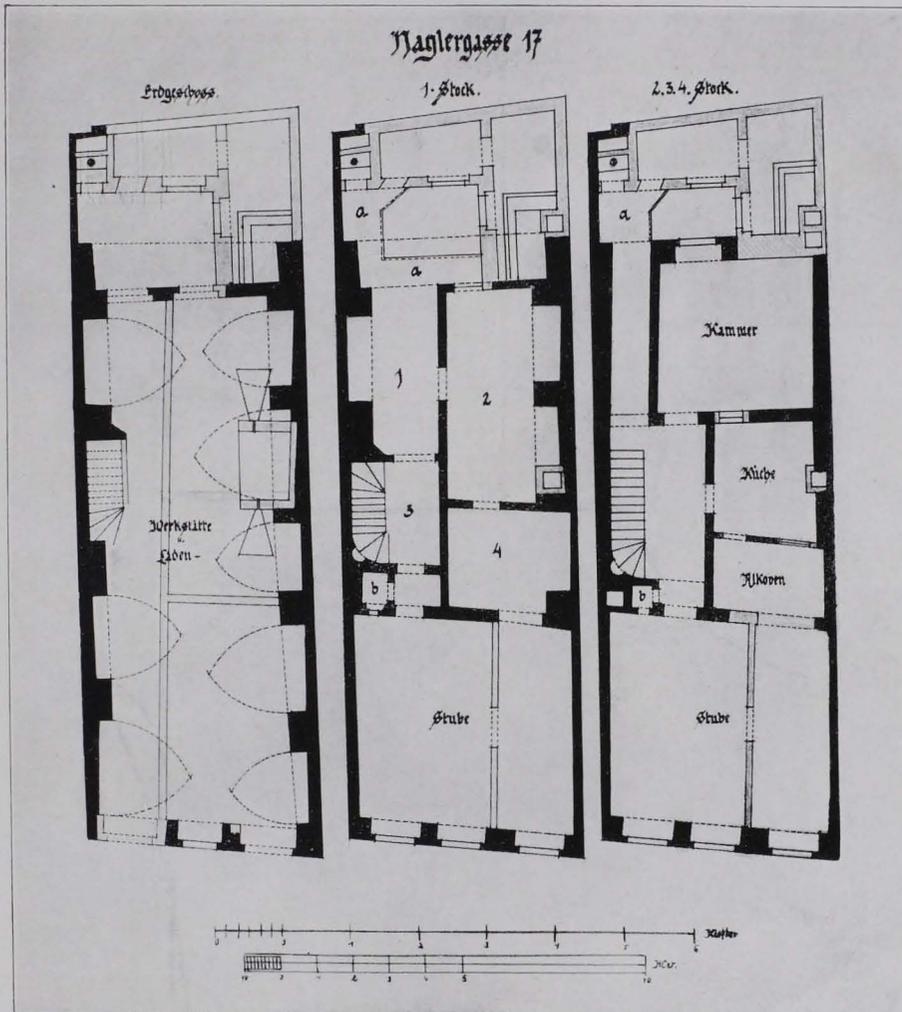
I., Naglergasse Nr. 17. Grundriß eines Handwerkerhauses mit Mietwohnungen aus dem XVI. Jh. Mittelalterliche schmale und tiefe Bauparzelle. Bodenständige Form.
